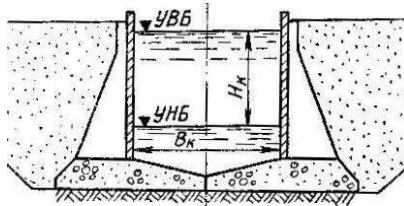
Железобетонная камера шлюза без продольных водопроводных галерей с контрфорсными стенами и разрезным дном
